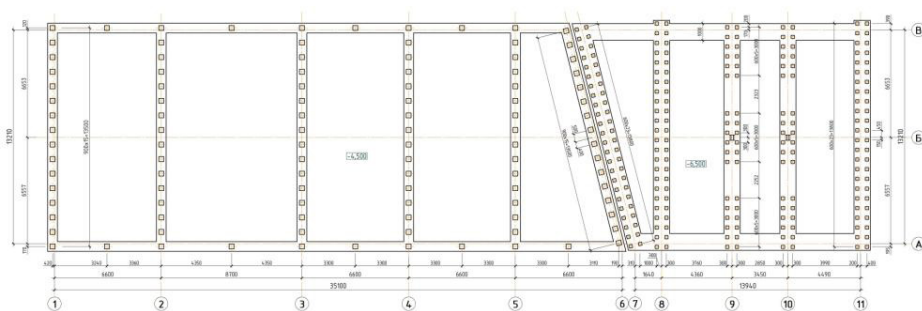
Схема расположения элементов свайно-грунтовых диафрагм
